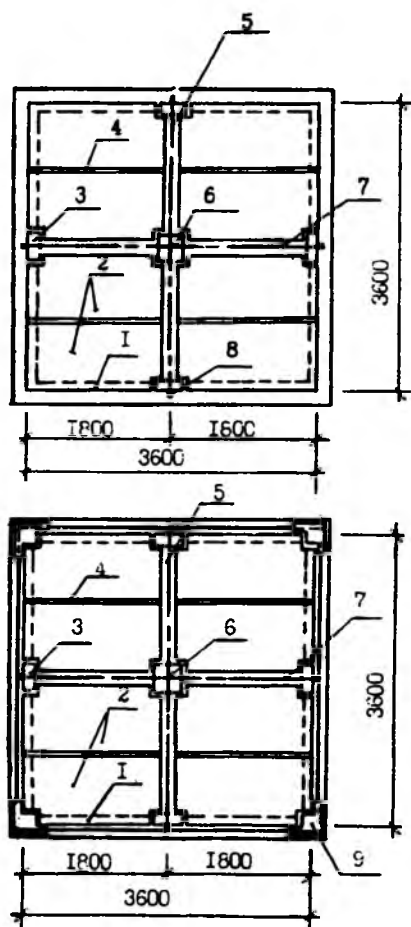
Сборно-монолитные перекрытия бескаркасных зданий с натяжением арматуры в построечных условиях
